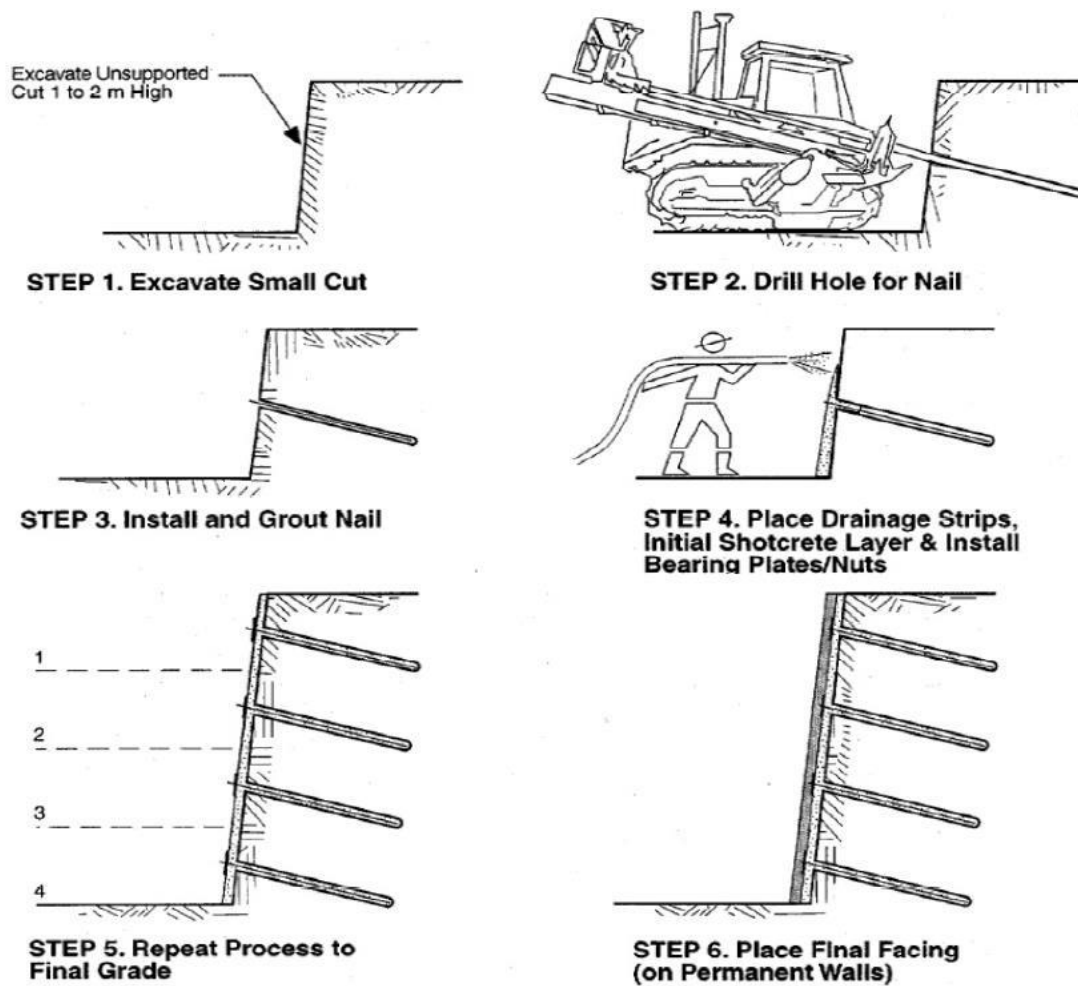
Proceso constructivo Soil Nailing (Rojo Pizarro, 2016)
